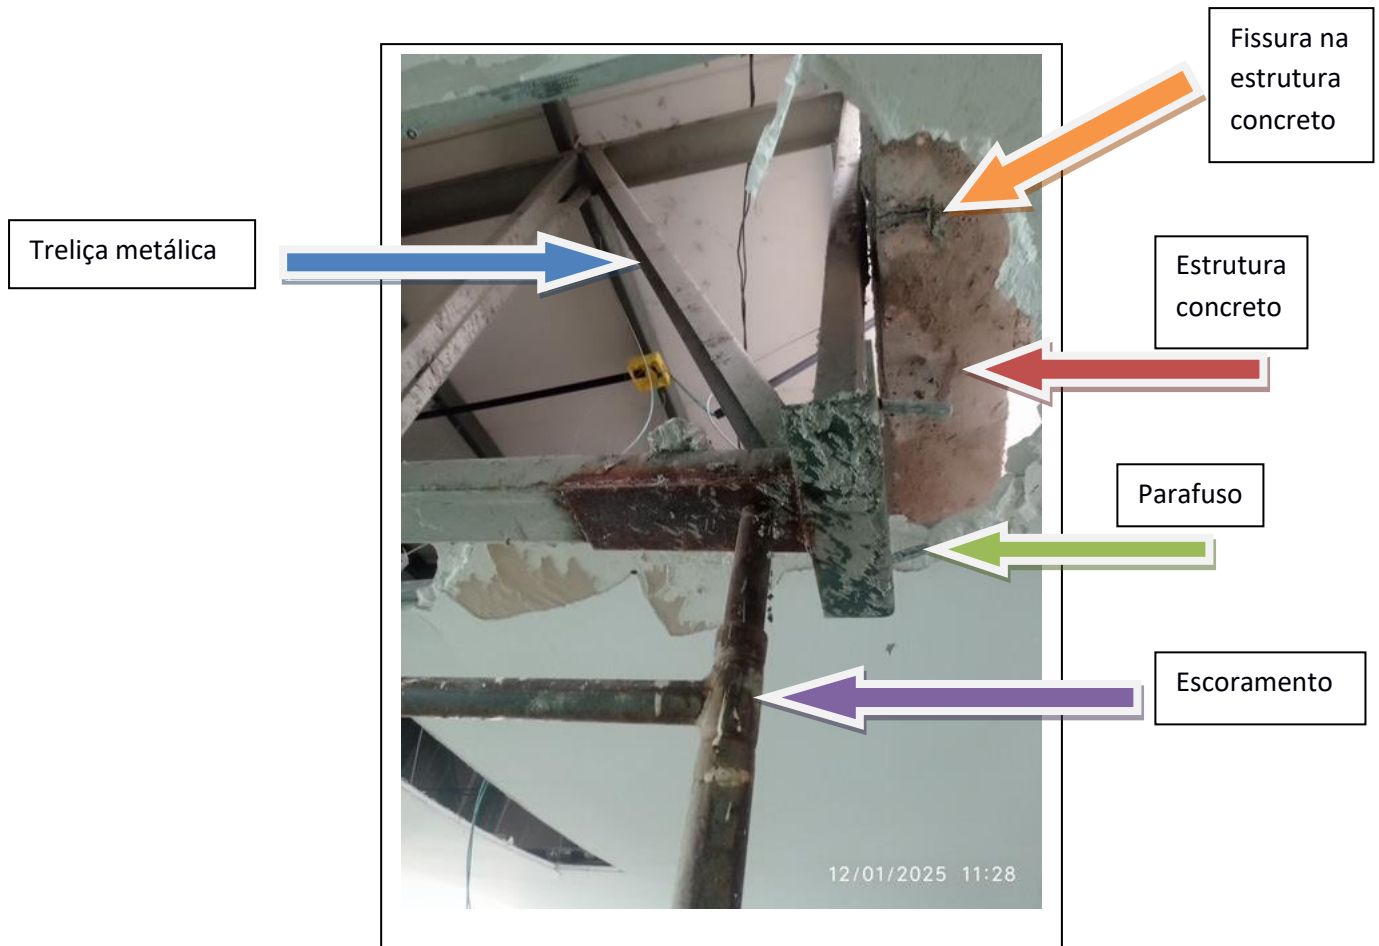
Parafusos fixados próximos ao bordo da estrutura desgastaram e provocaram a queda da treliça e fissura na estrutura de concreto.
